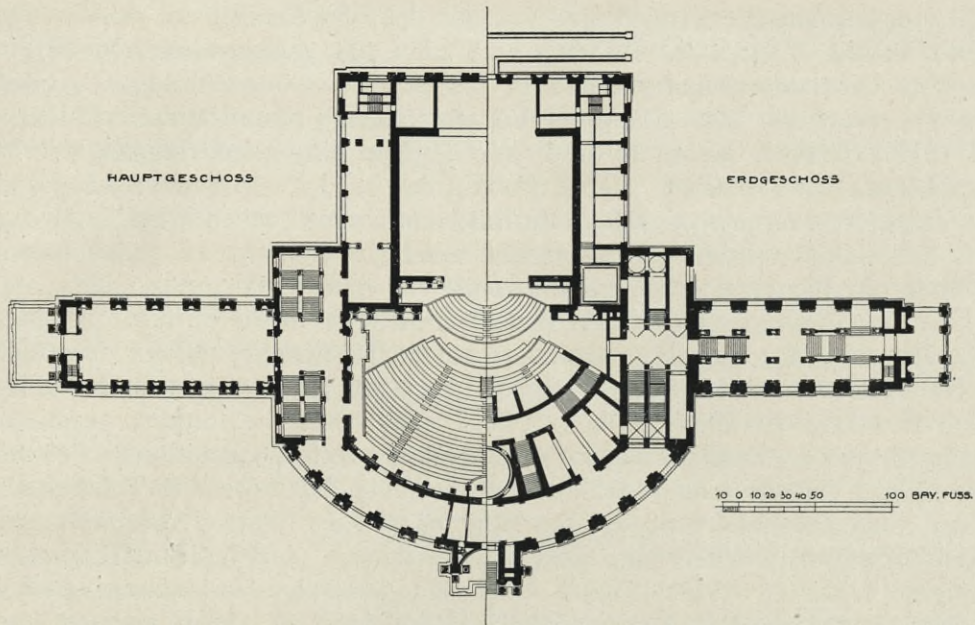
Gottfried Sempers Entwurf vom Jahre 1867 für den Festbau zu München. Grundriß.<sup>109)</sup>
